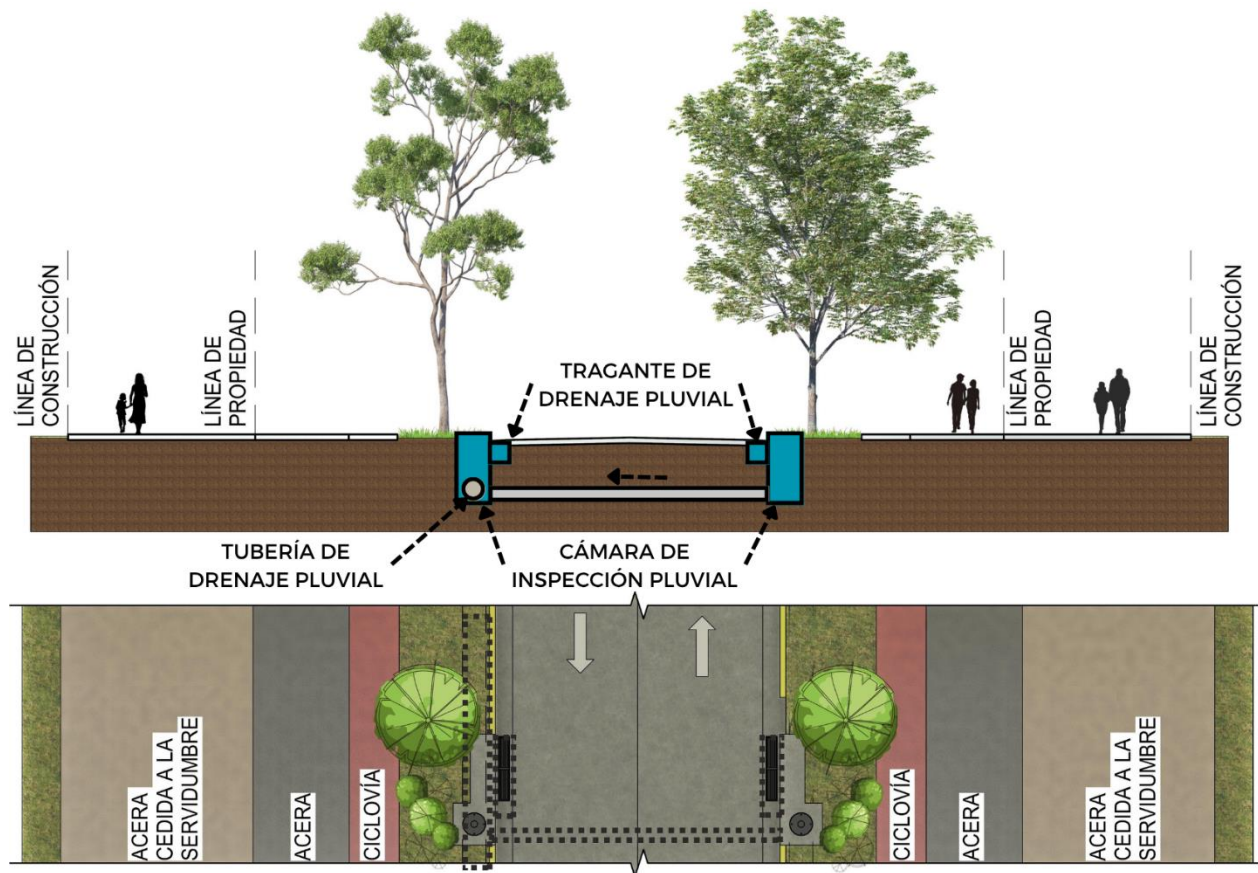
Detalle de ubicación para los tragantes y alcantarillado pluvial | Elaborado por: El autor
